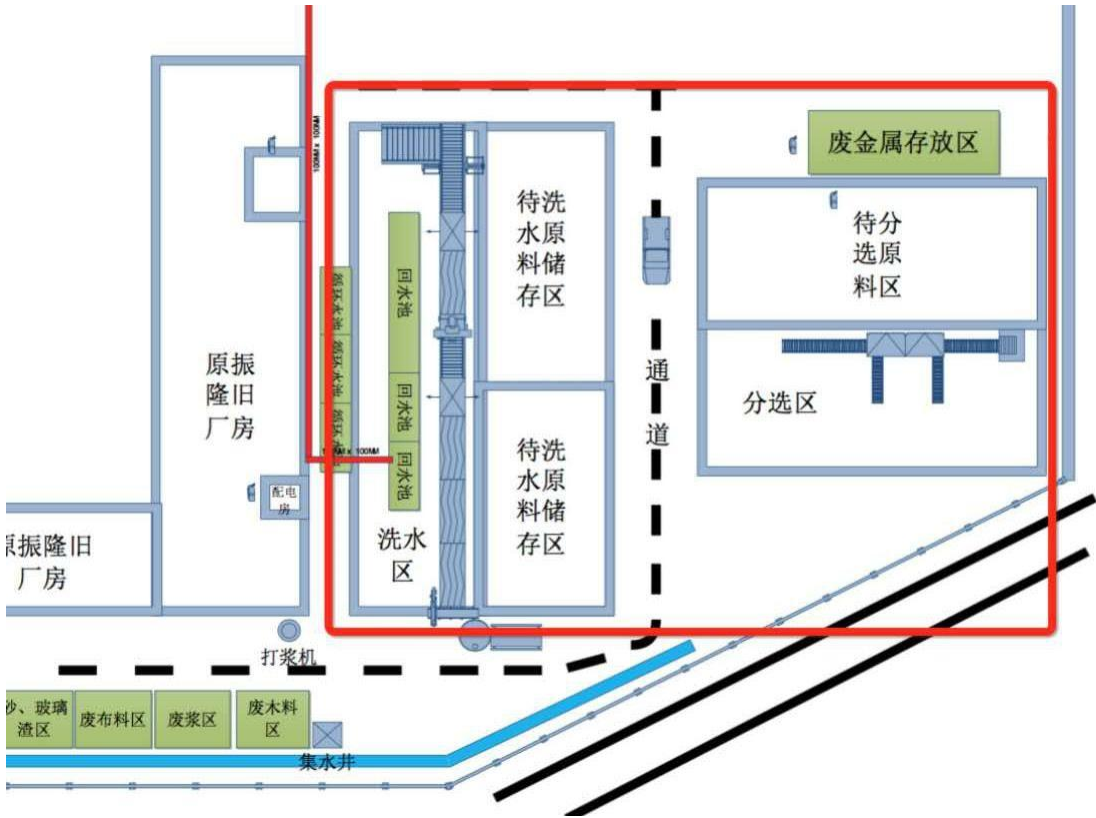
原有项目平面图（红色区域为本项目租用区域）
